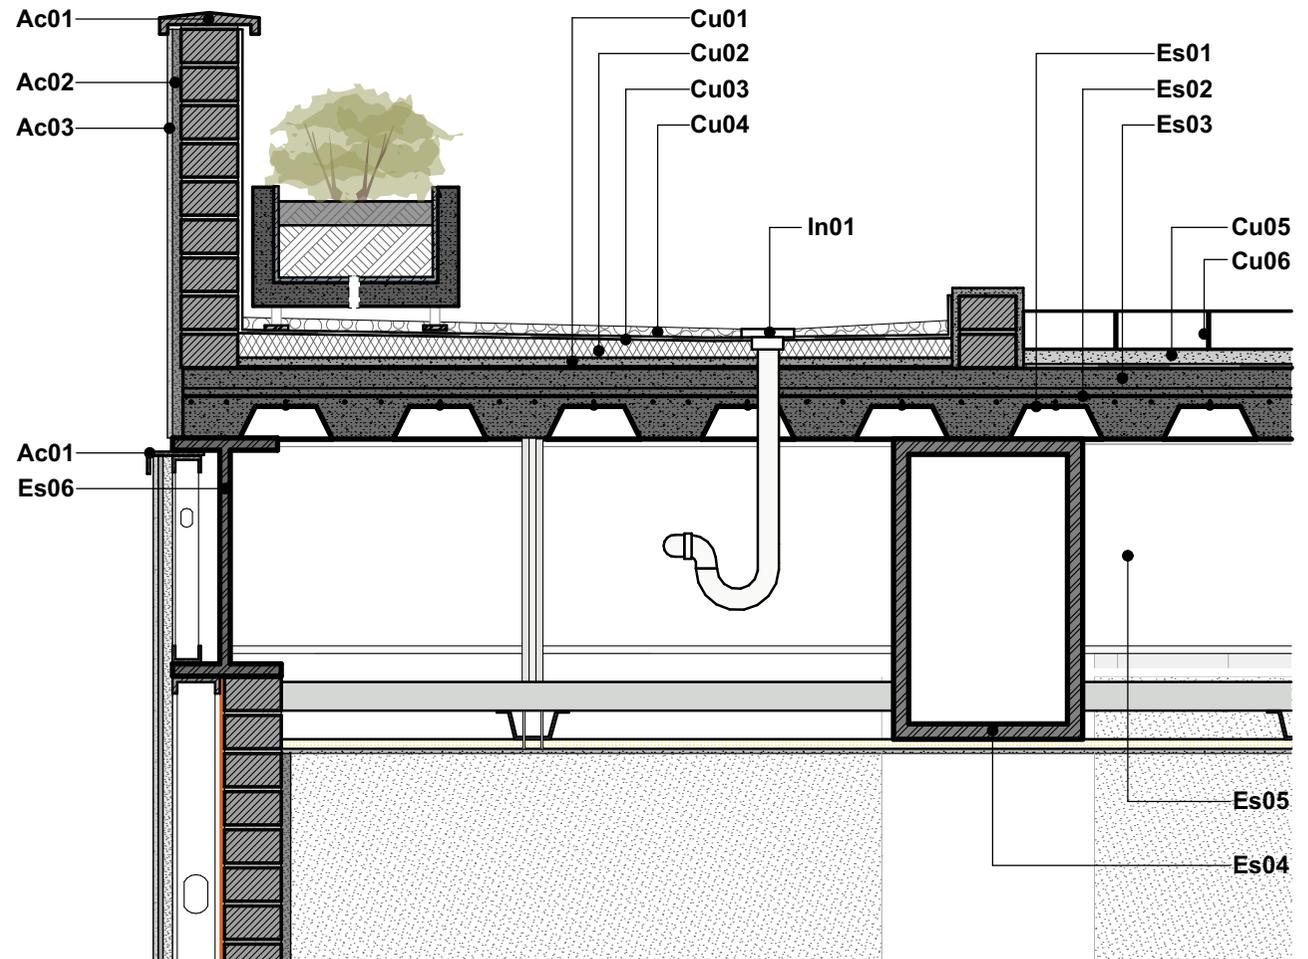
Detalle constructivo. Fuente: Elaboración propia
